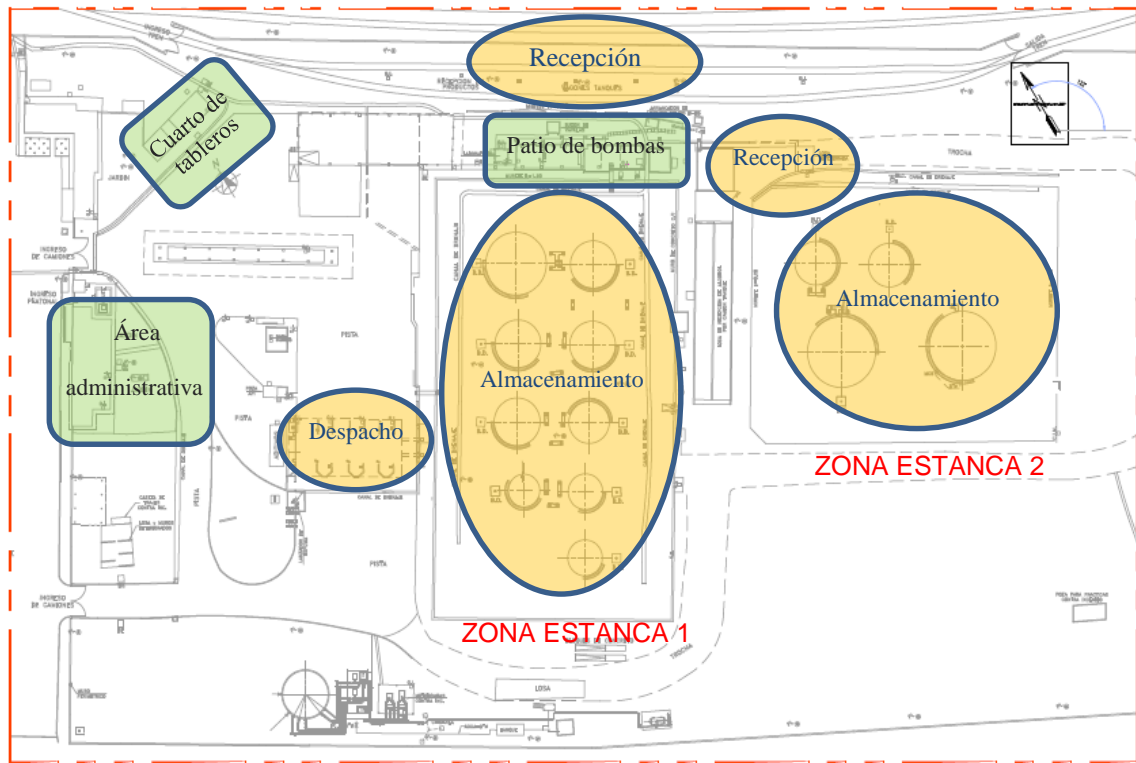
Áreas de trabajo de la planta PETROPERÚ.
